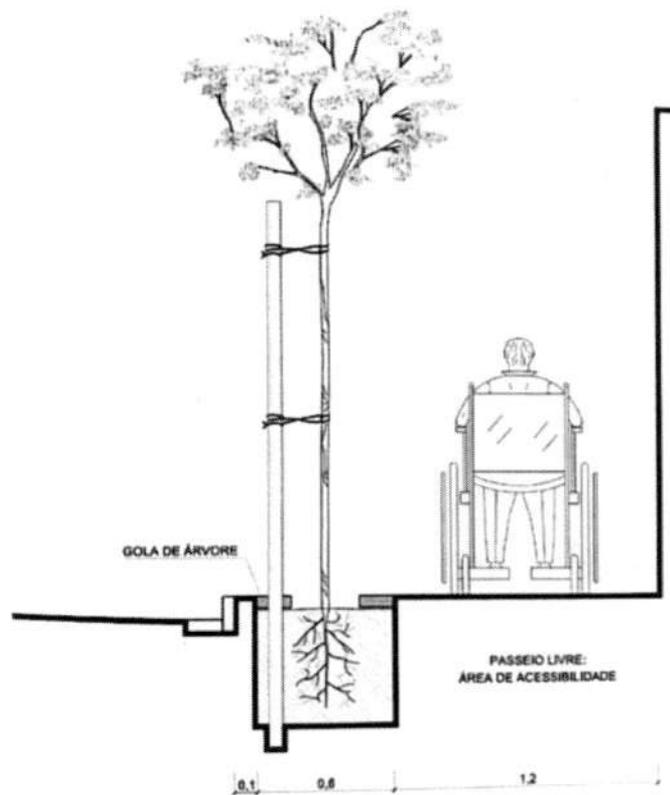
Corte esquemático do canteiro para plantio de árvores
